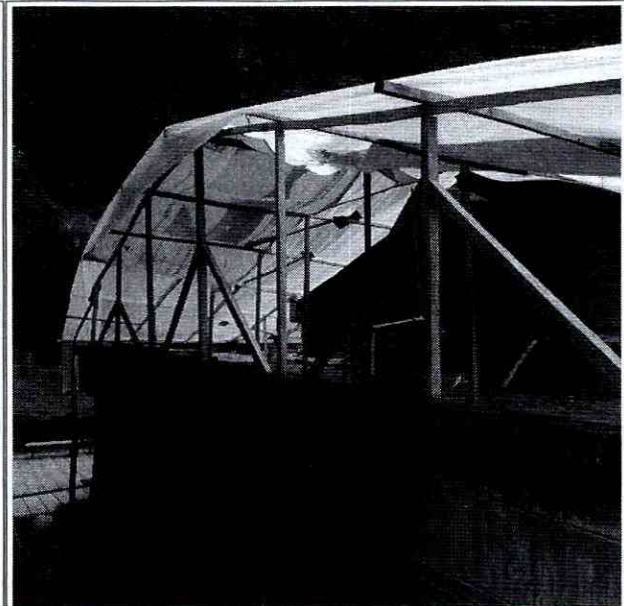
Estructura en madera y polietileno construida para evitar filtraciones
